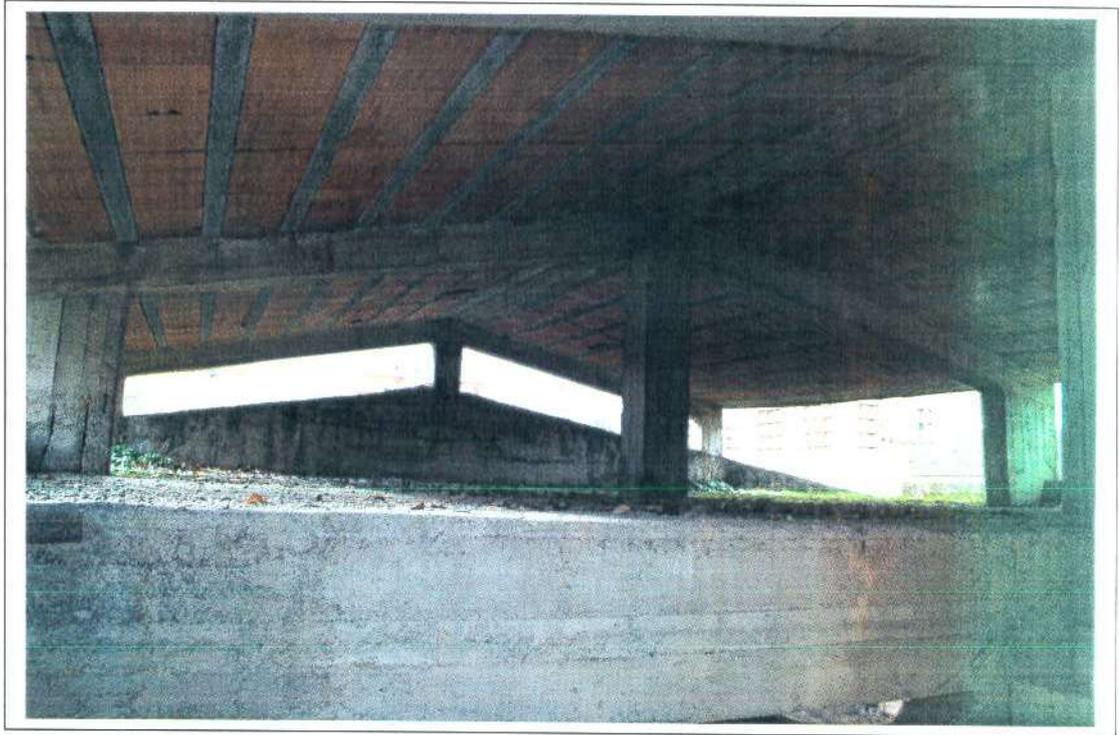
Veduta sottotetto corpo Ingresso su Via Pigafetta
